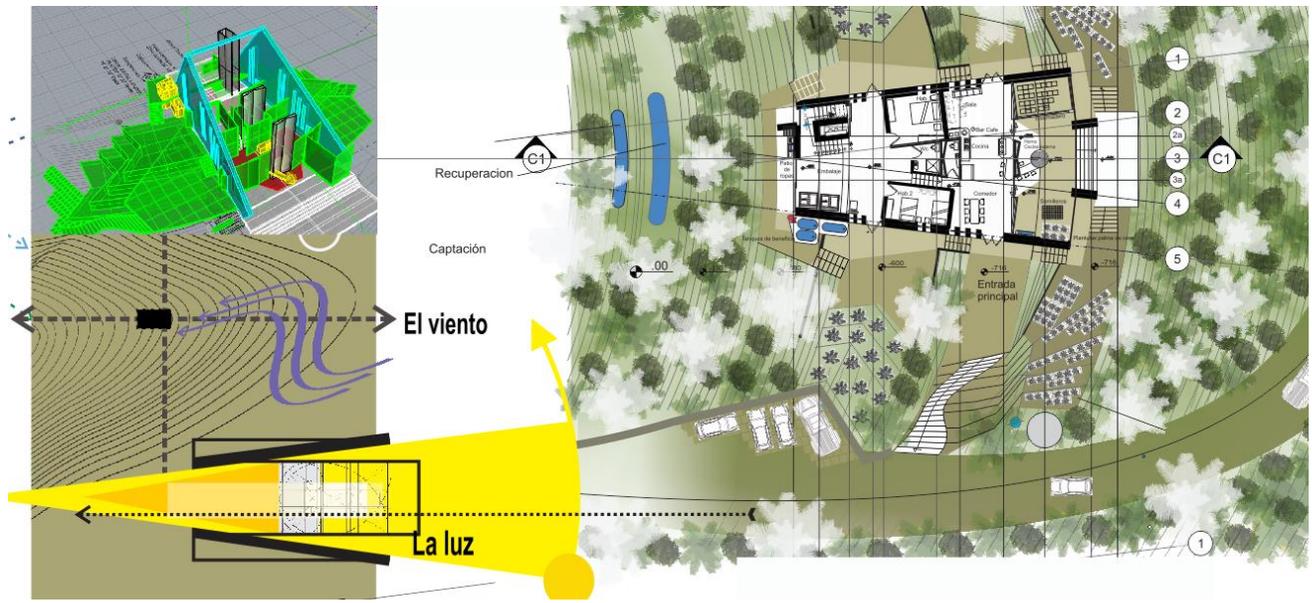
| Diagrama diseño y planta 1 elaboración propia
